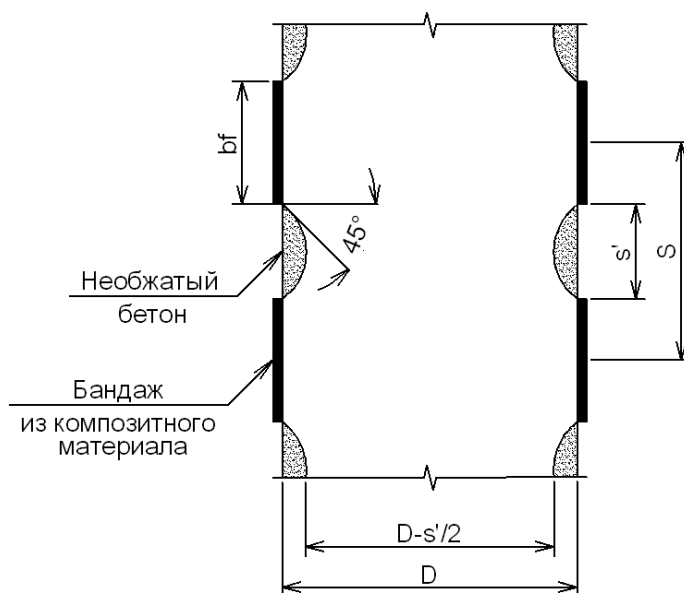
Расчетная схема колонны, усиленной отдельными бандажами (разреженное по высоте усиление).
